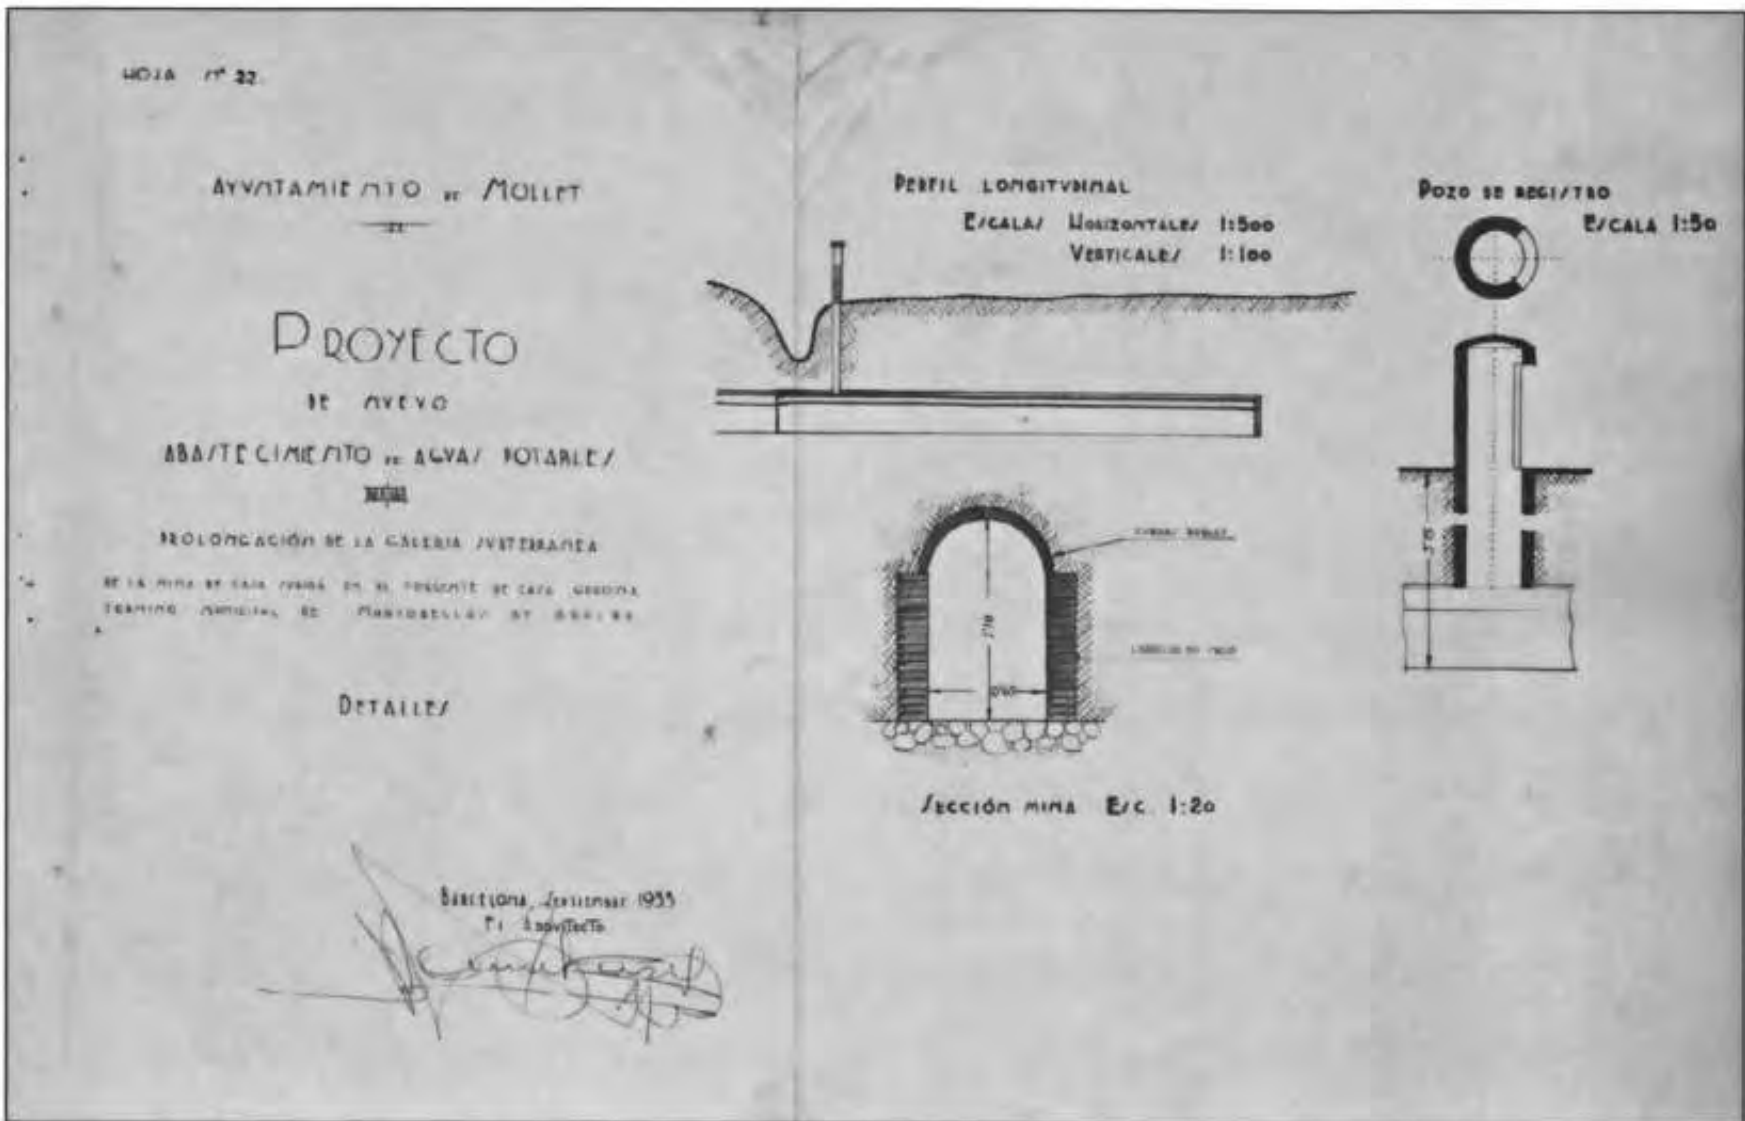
Detalls constructius de l'allargament de la mina can Subirà
